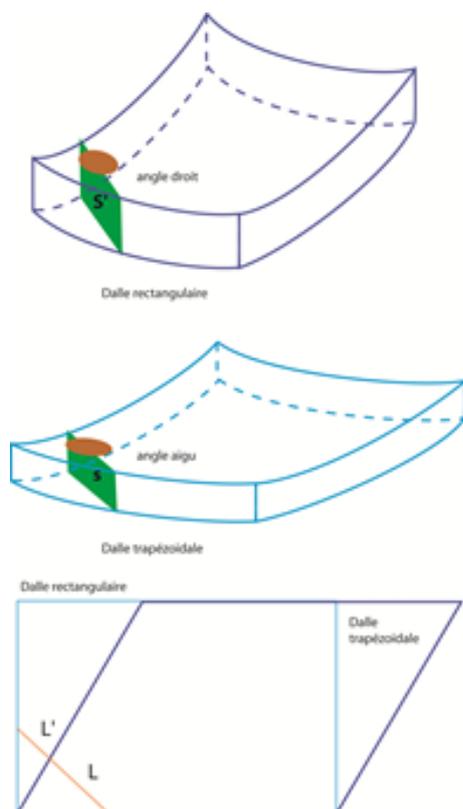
La section tendue sous la charge est plus faible en bas dans la dalle en "losange"
